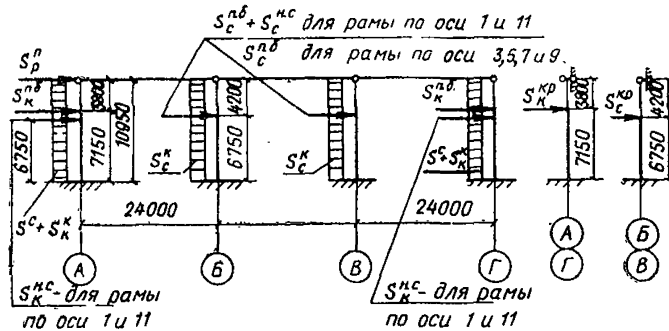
Расчетная схема поперечной рамы каркаса здания
